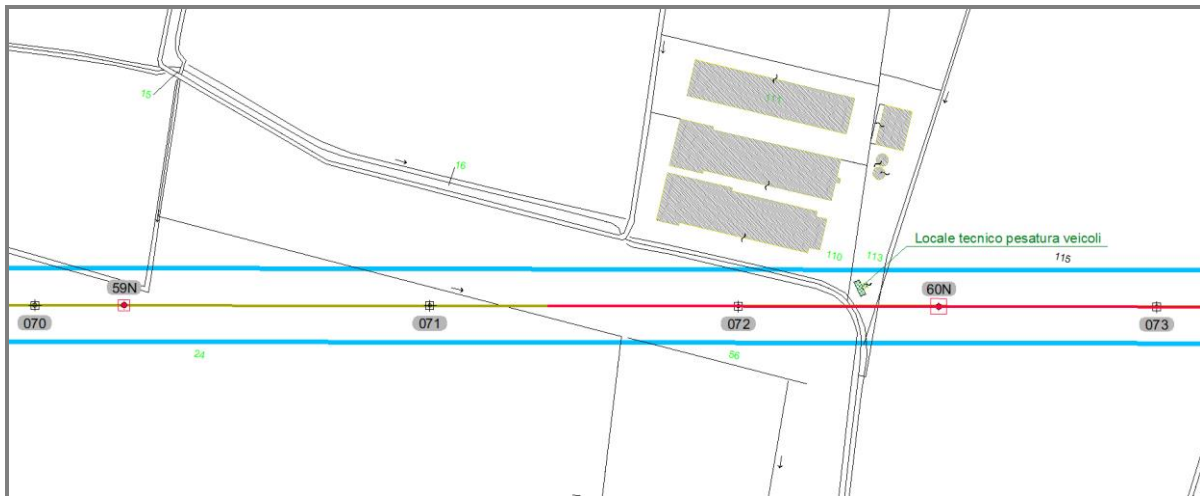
Stralcio Planimetria catastale con fascia DpA – Campate 159N-160N-161N
